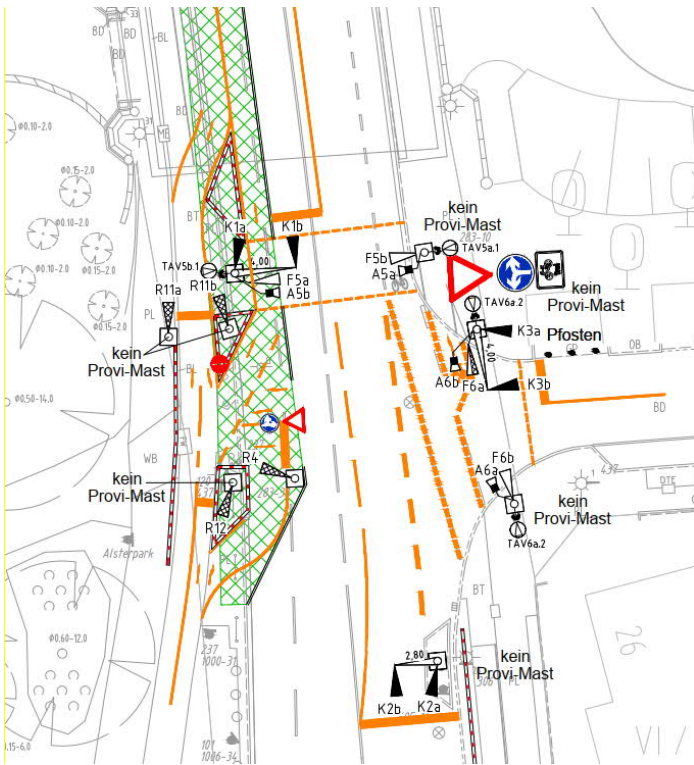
Lageplan-Ausschnitt mit Knotenpunkt Schwanenwik / Armgartstraße (Bauzustand; Quelle: BKP)
